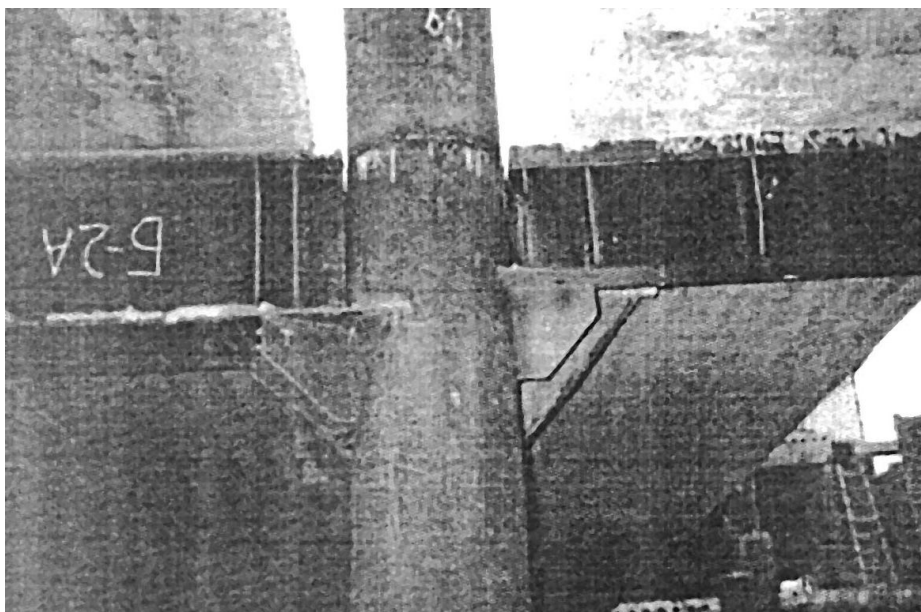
Узел сопряжения трубобетонной колонны с ригелем при строительстве многоэтажного промышленного здания
